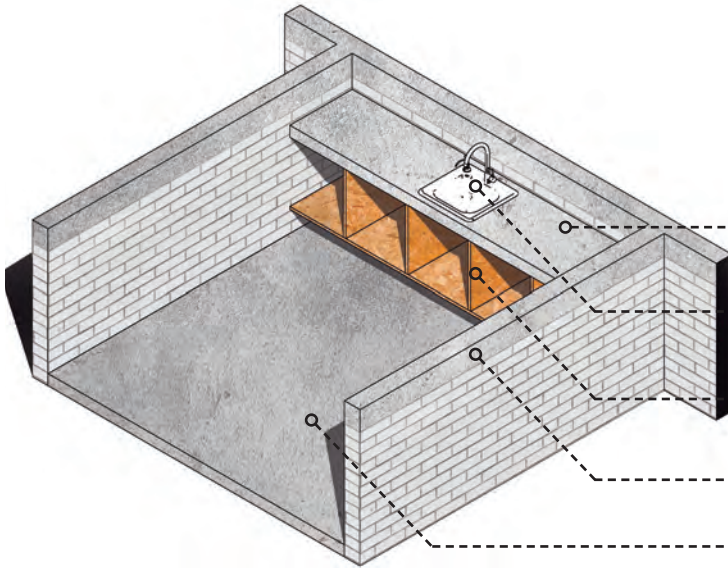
PLANTA BAJA ISOMÉTRICO.
